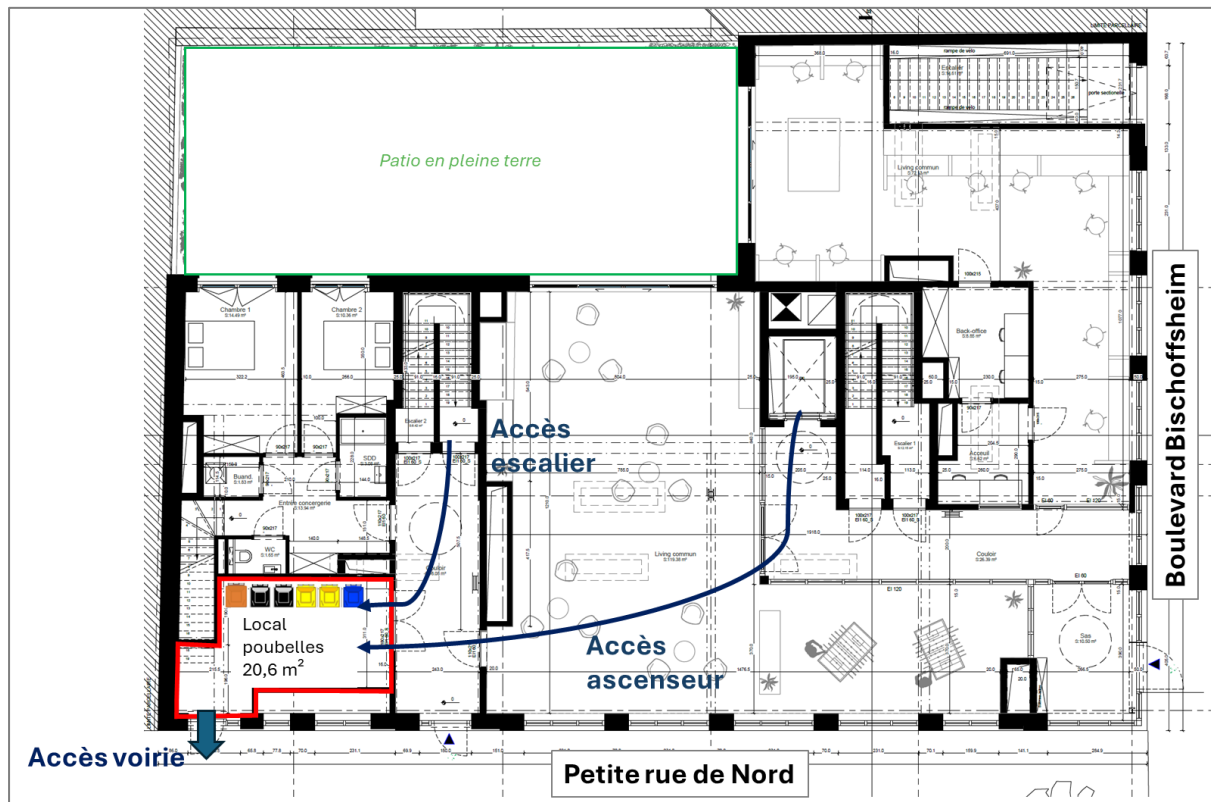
Localisation du local poubelles et de ses accès (source du fond de plan : B2Ai)
